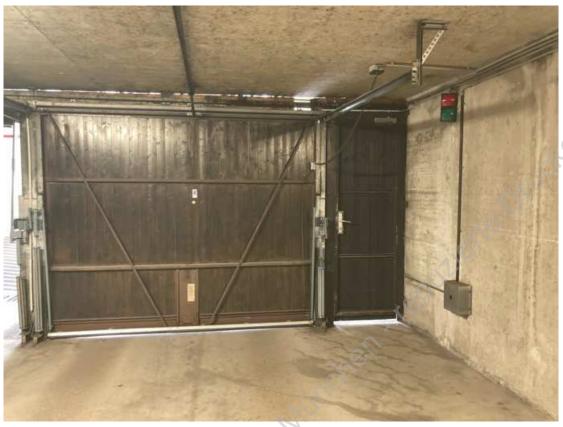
Ausfahrtstor mit seitlichem Ausgang
